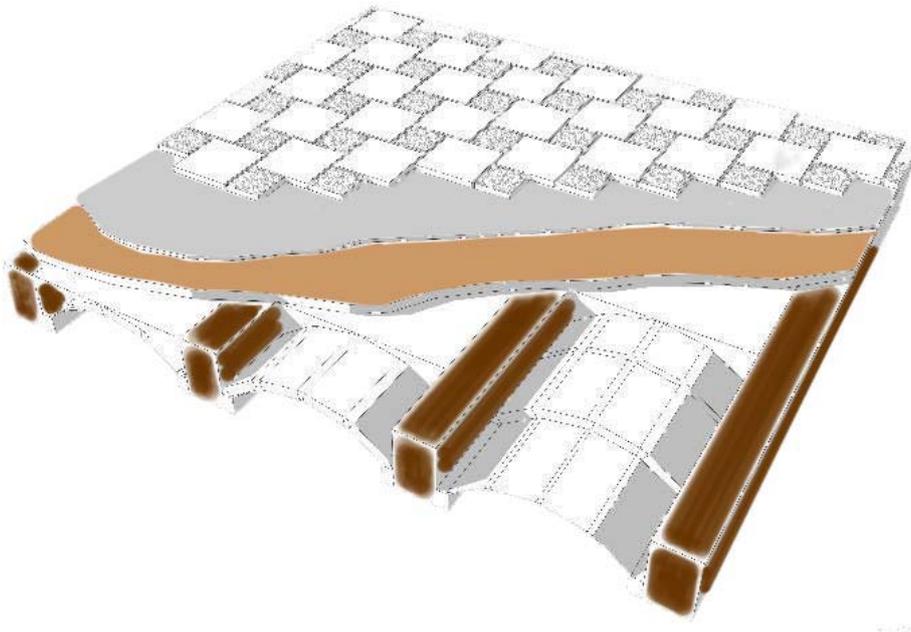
Detalle constructivo del forjado. Fuente Propia. 2016
